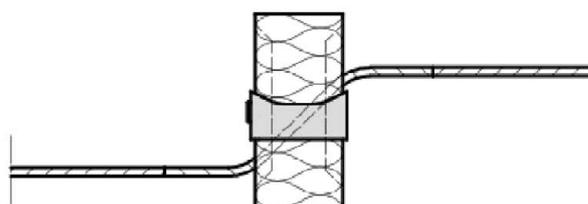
Schöck Isokorb® Typ K-ID mit
